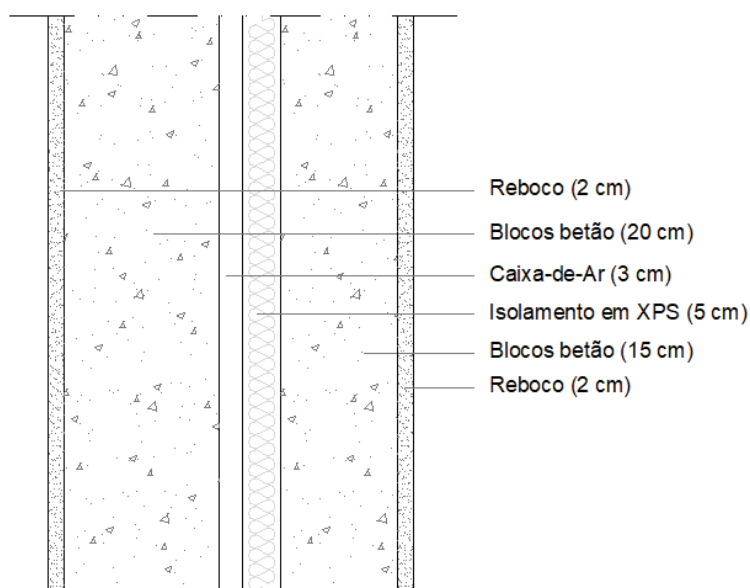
Pormenor construtivo da parede exterior tipo I
